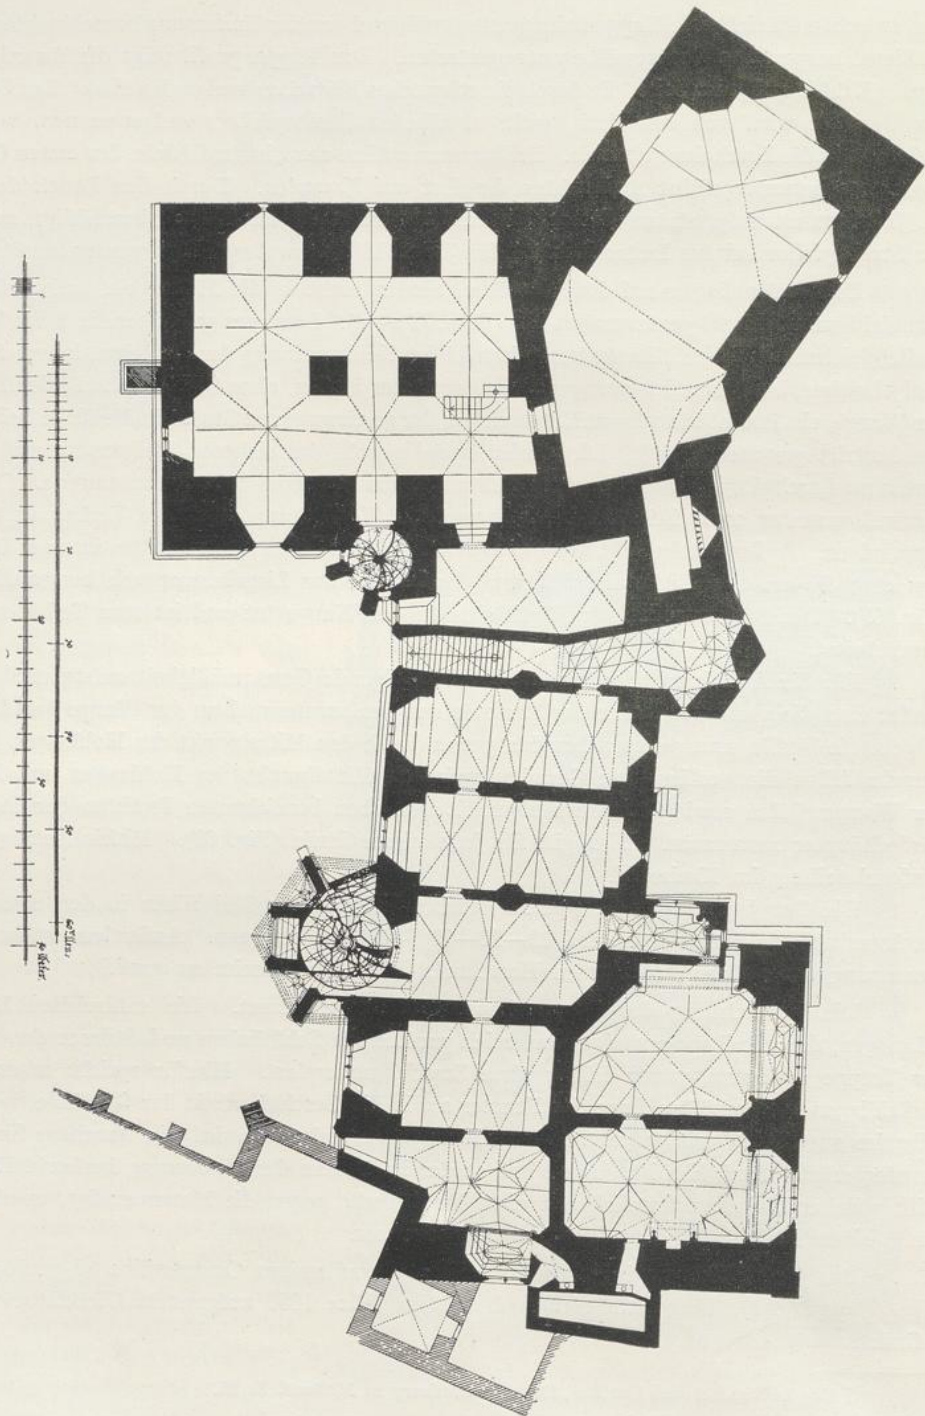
Albrechtsburg zu Meißen. Grundriß des Erdgeschosses.
